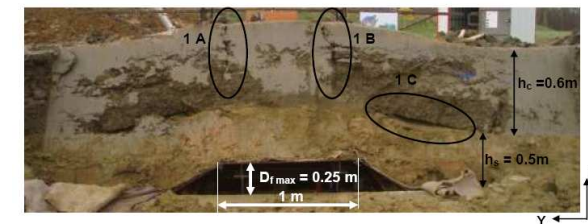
Coupe verticale de la planche T1 à la fin de l'essai d'après Camp (2008).
